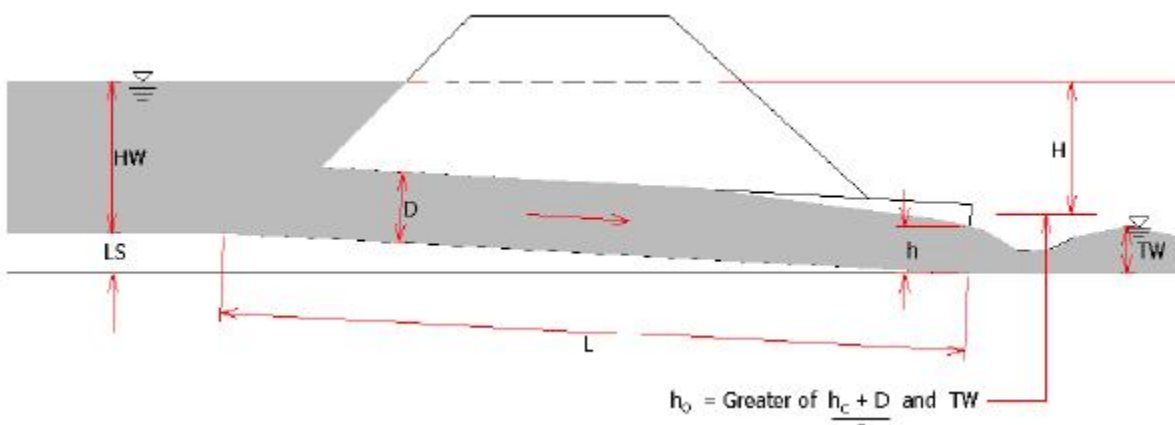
แสดง Flow Profiles for Culvert under Ountral
